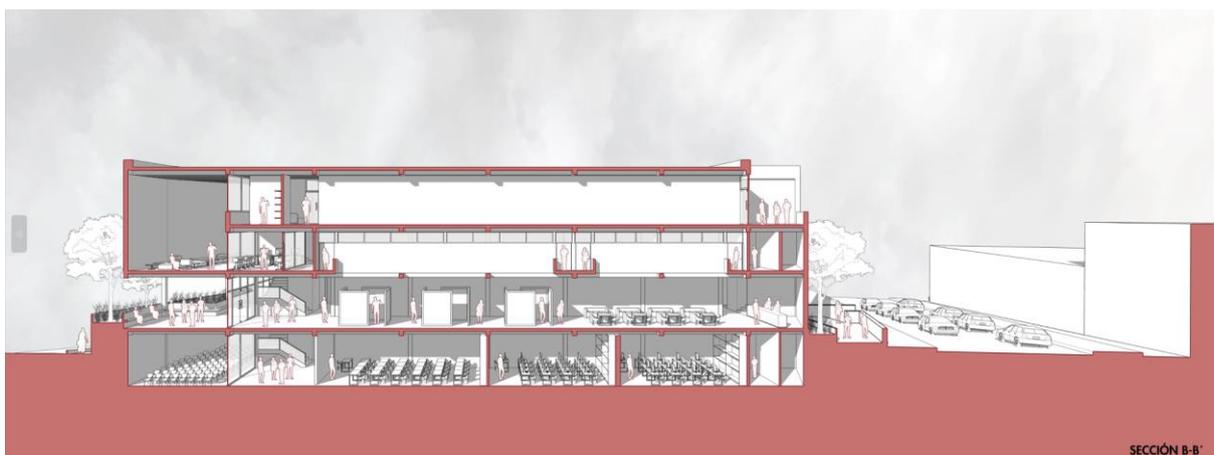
Corte Fugado Longitudinal B-B'. Ilustración del Autor.
